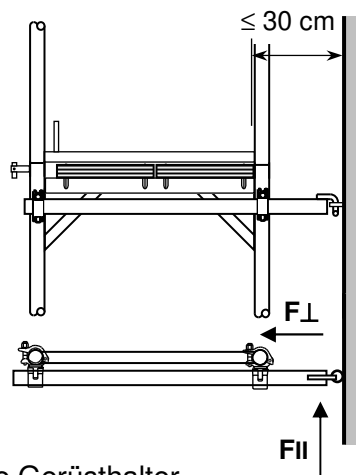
Höhenlage der Gerüsthalter bei Anschluss im „Knoten“
